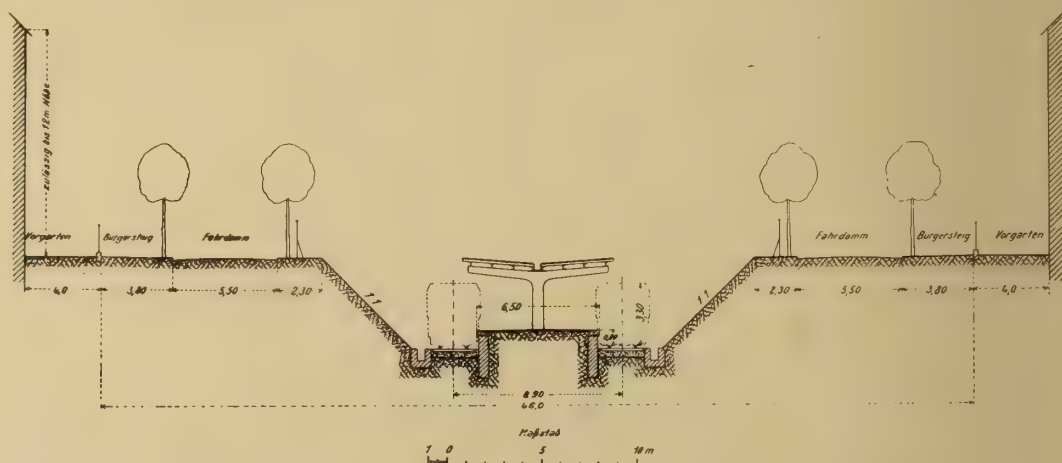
Straße mit Haltestelle der Einschnittbahn in Dahlem.
